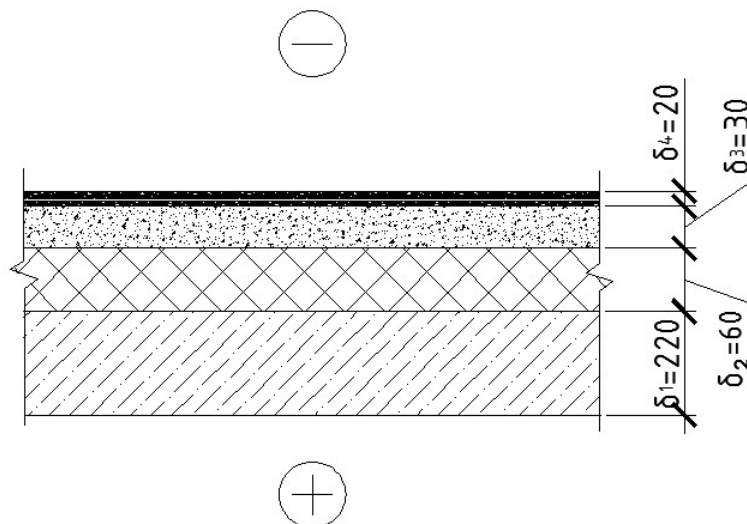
Розрахункова схема перекрыття над неопалюваним підвалом
